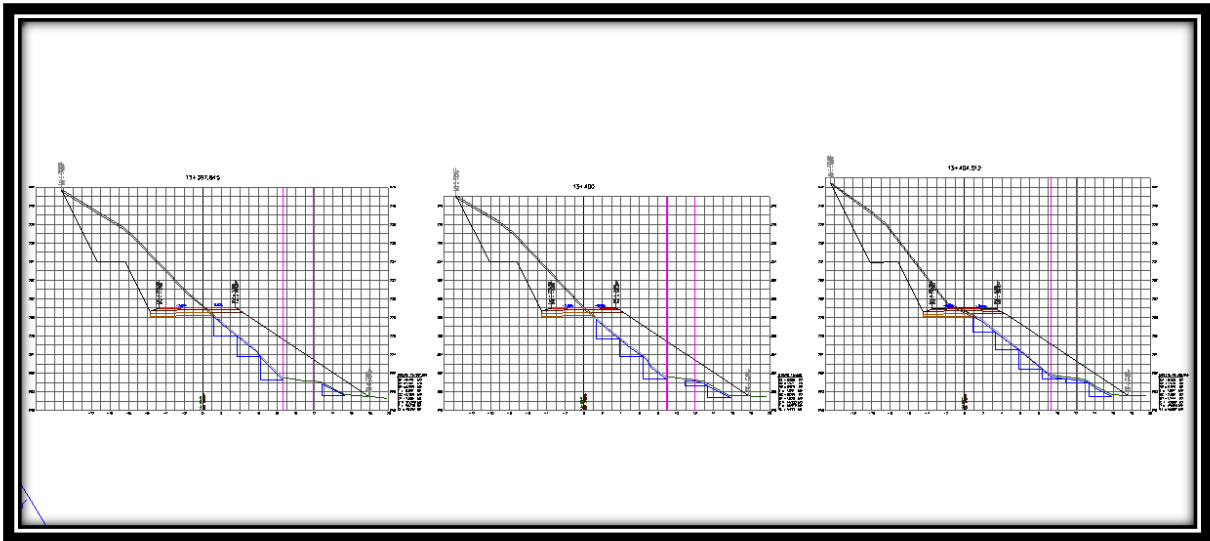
Secciones de construcción del km 13+397.845 al km 13+404.512.
